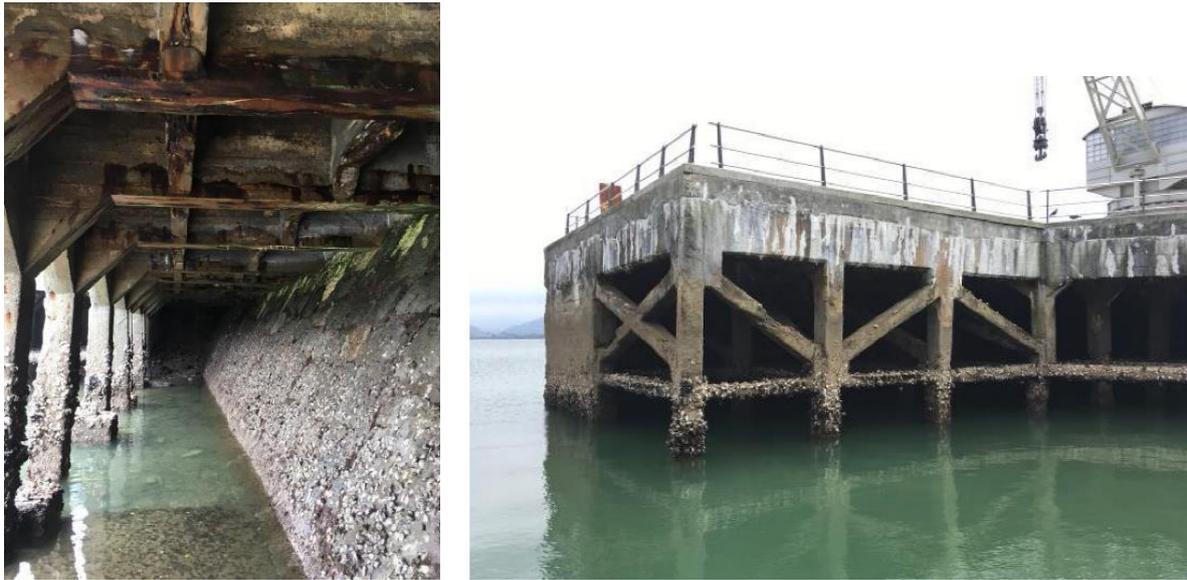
Corrosión avanzada y pérdida de materiales en vigas y pilares del interior de los pórticos del muelle (izquierda); vista de la estructura exterior desde el mar, en las inmediaciones de la “Grúa de piedra”, a la derecha (Fotografías de [8] y [14]).
